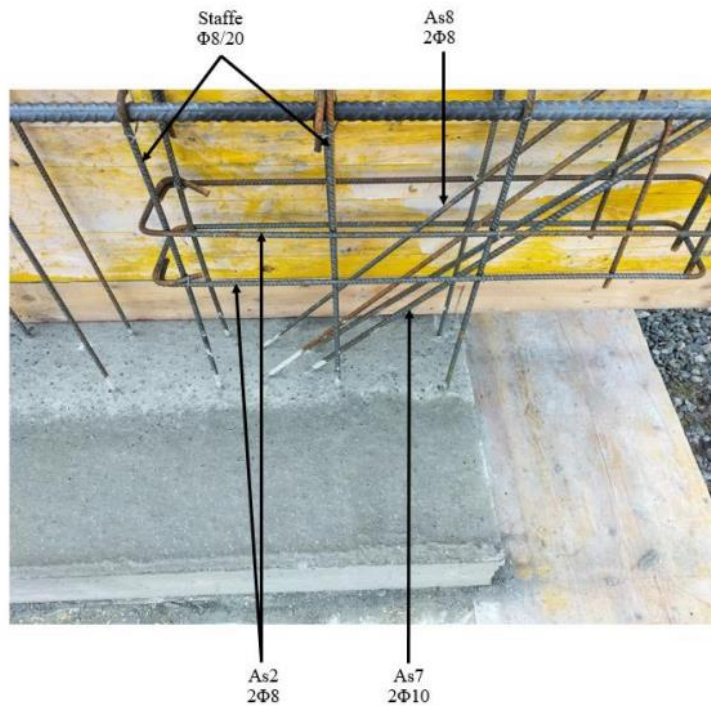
Disposizione armatura schema B, lato sano [2], [23]
